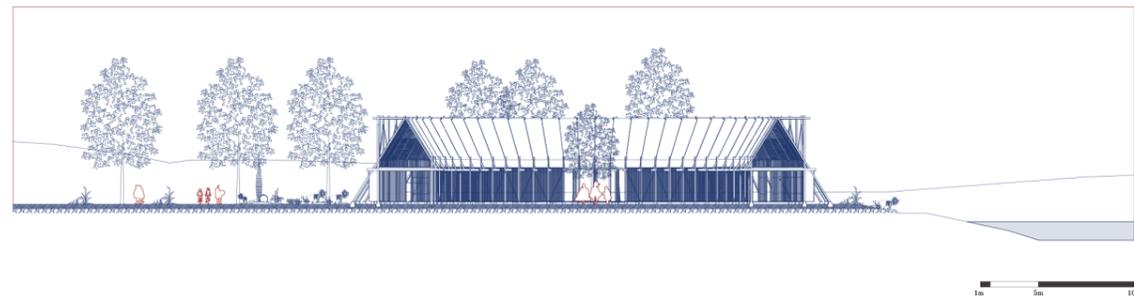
Corte BB' Norte - Sur. Fuente: Elaboración propia
